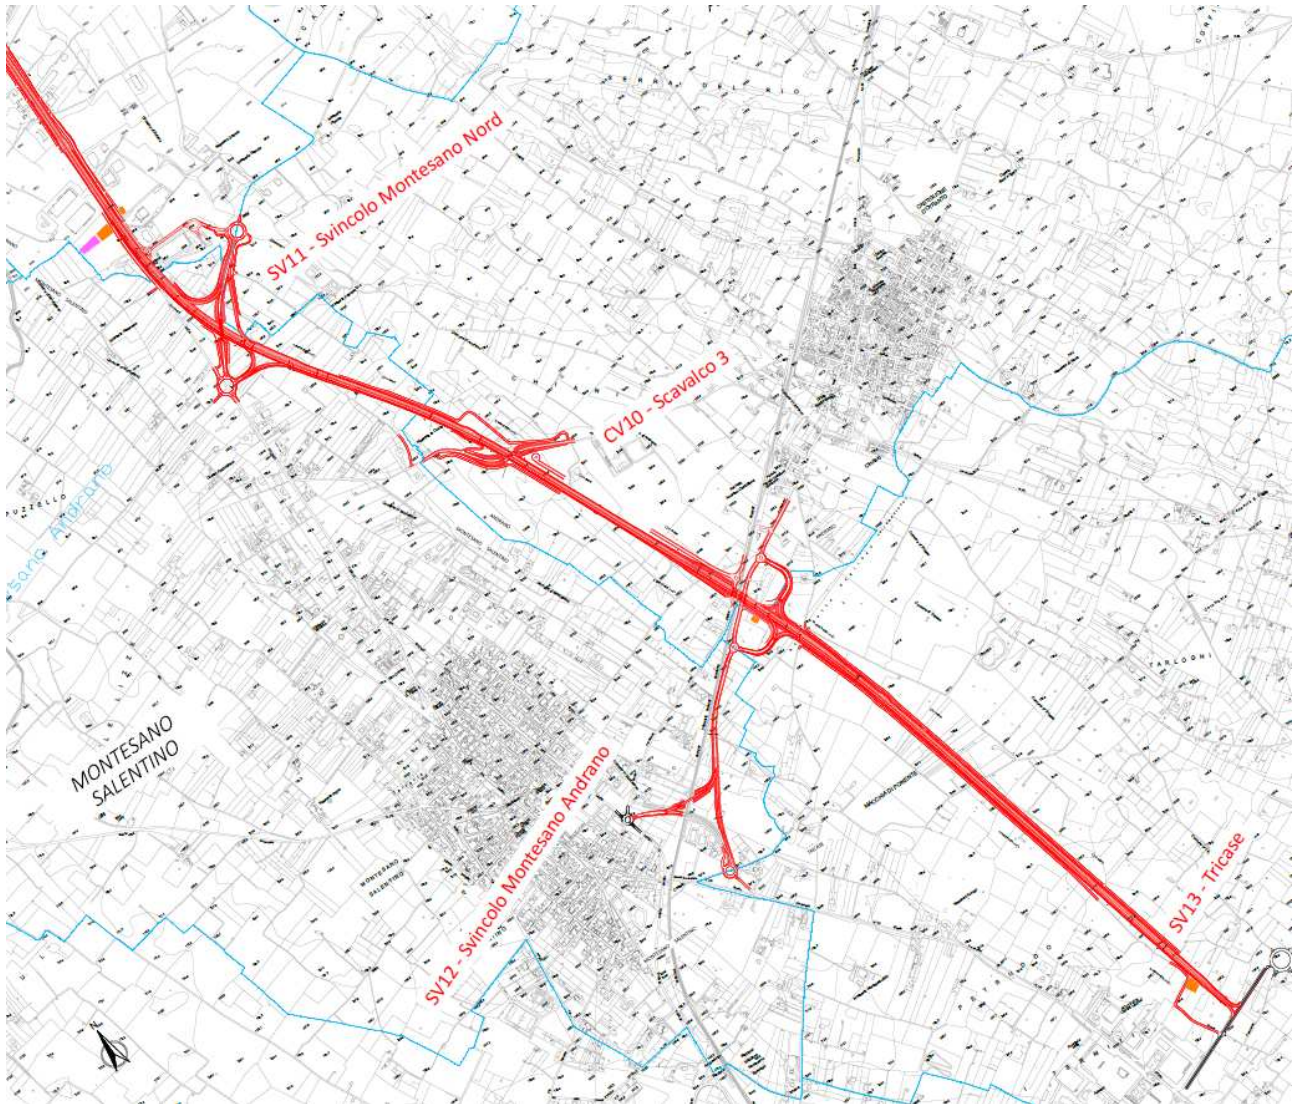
Planimetria complessiva dell'intervento su base CTR – 5 di 5
